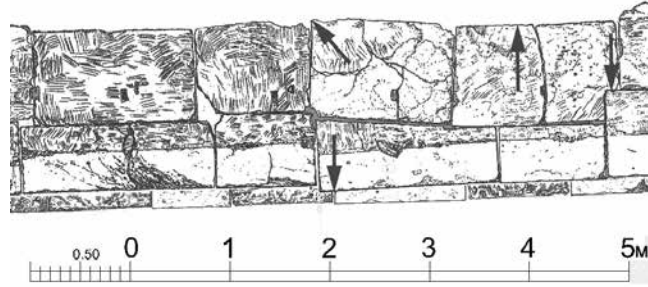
Pianta del lato S con spostamenti, tempio arcaico (N. Hellner)
